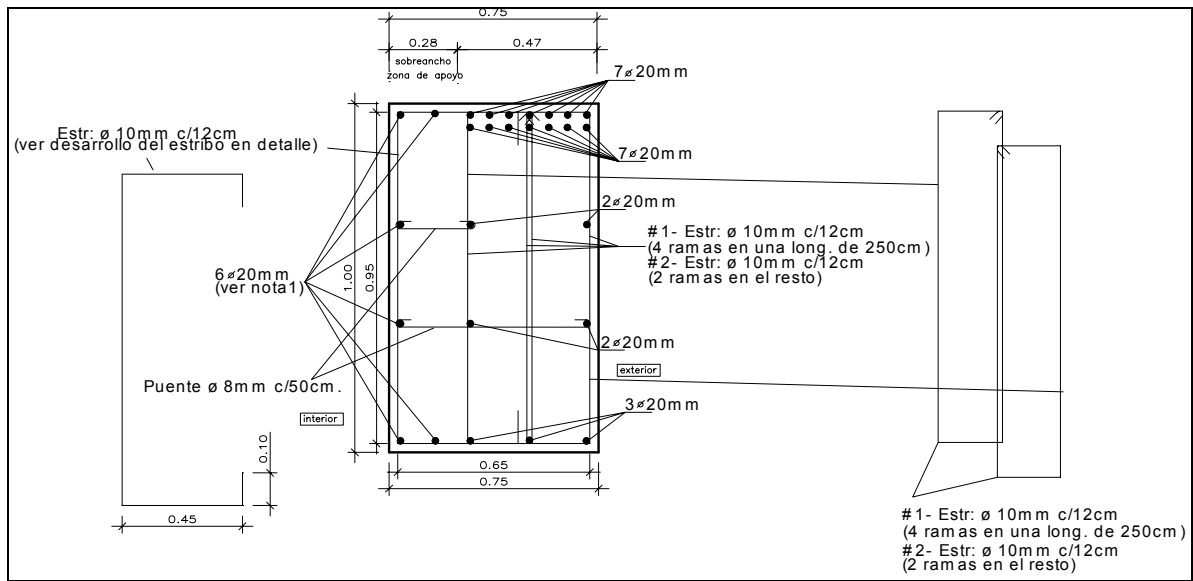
Detalle de disposición de armaduras en vigas de fundación ubicada por debajo del sistema de aislamiento, tramo donde se emplaza el sistema de aislamiento (Ver también Capítulo 9).
